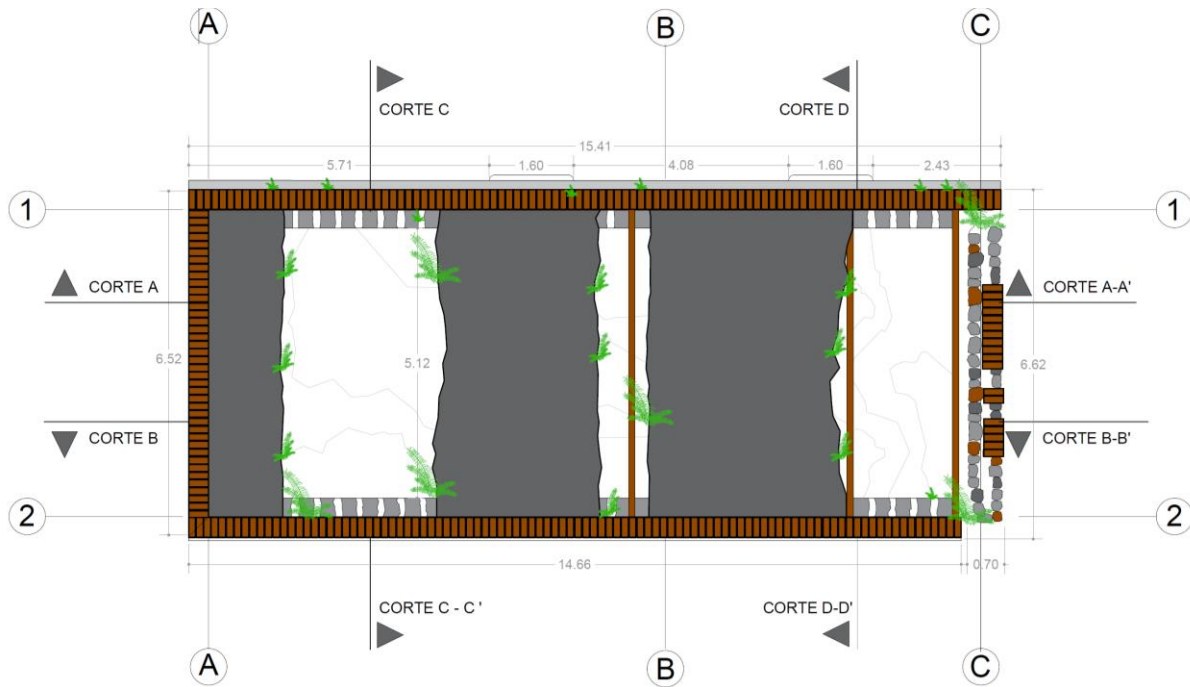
Planta techumbre, sin escala. Elaboración propia
